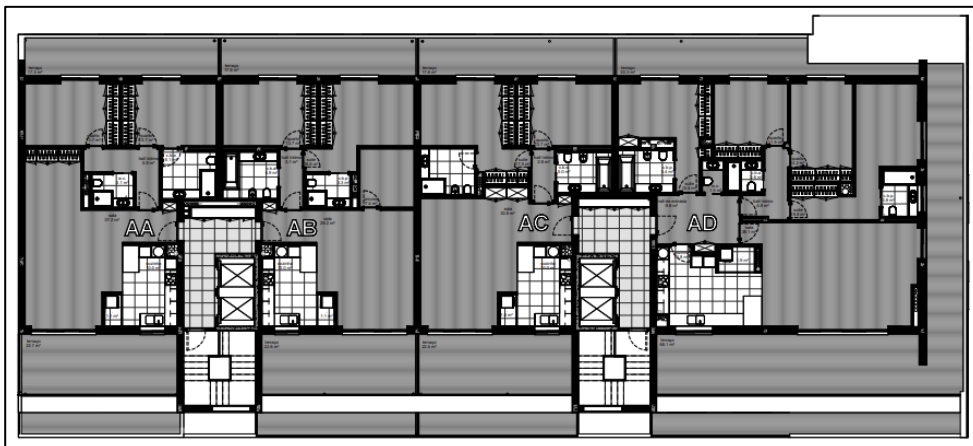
Recorte da planta de arquitetura do piso 5 do edifício Altavista 16 (1).
